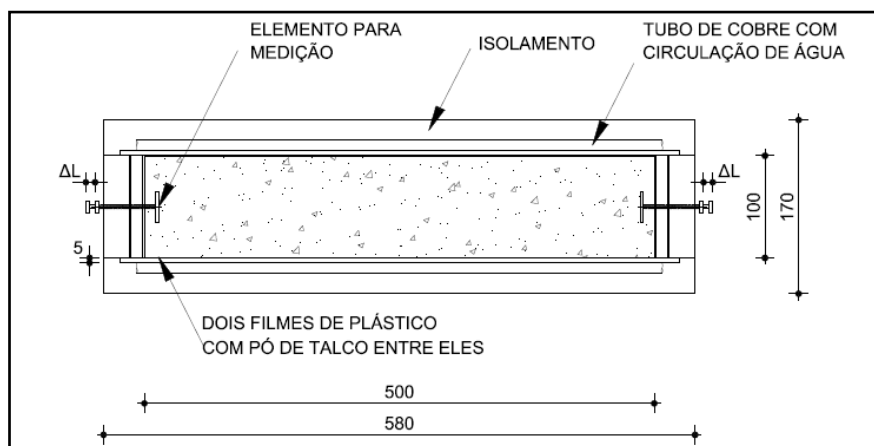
Equipamento para medição da retracção autogénea em betões (Adaptado de [185])
